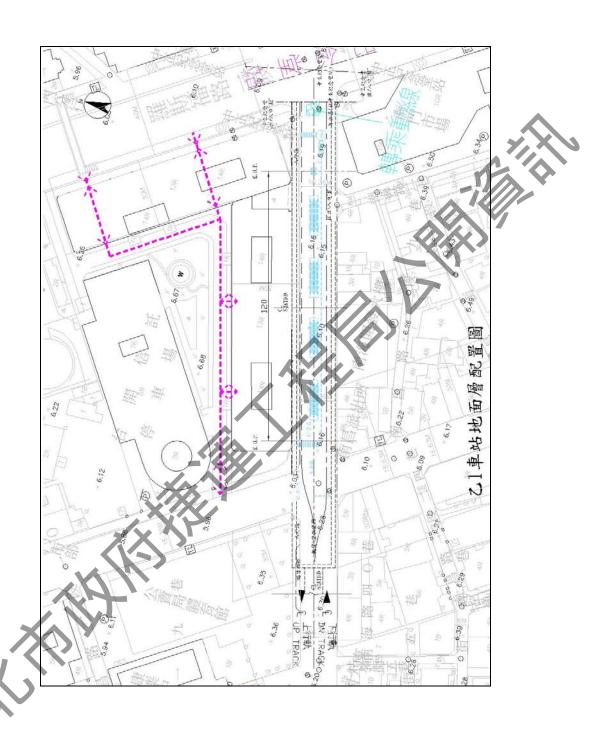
乙 1 車站地面層位置平面配置圖
